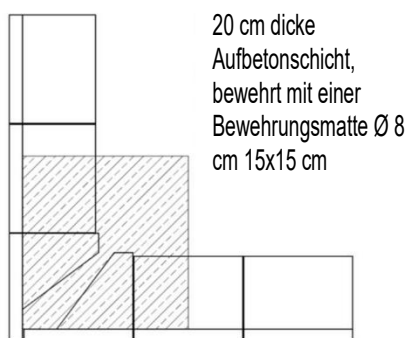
Schematische Darstellung der Ausführung einer Ecke mit einer Aufbetonschicht.
